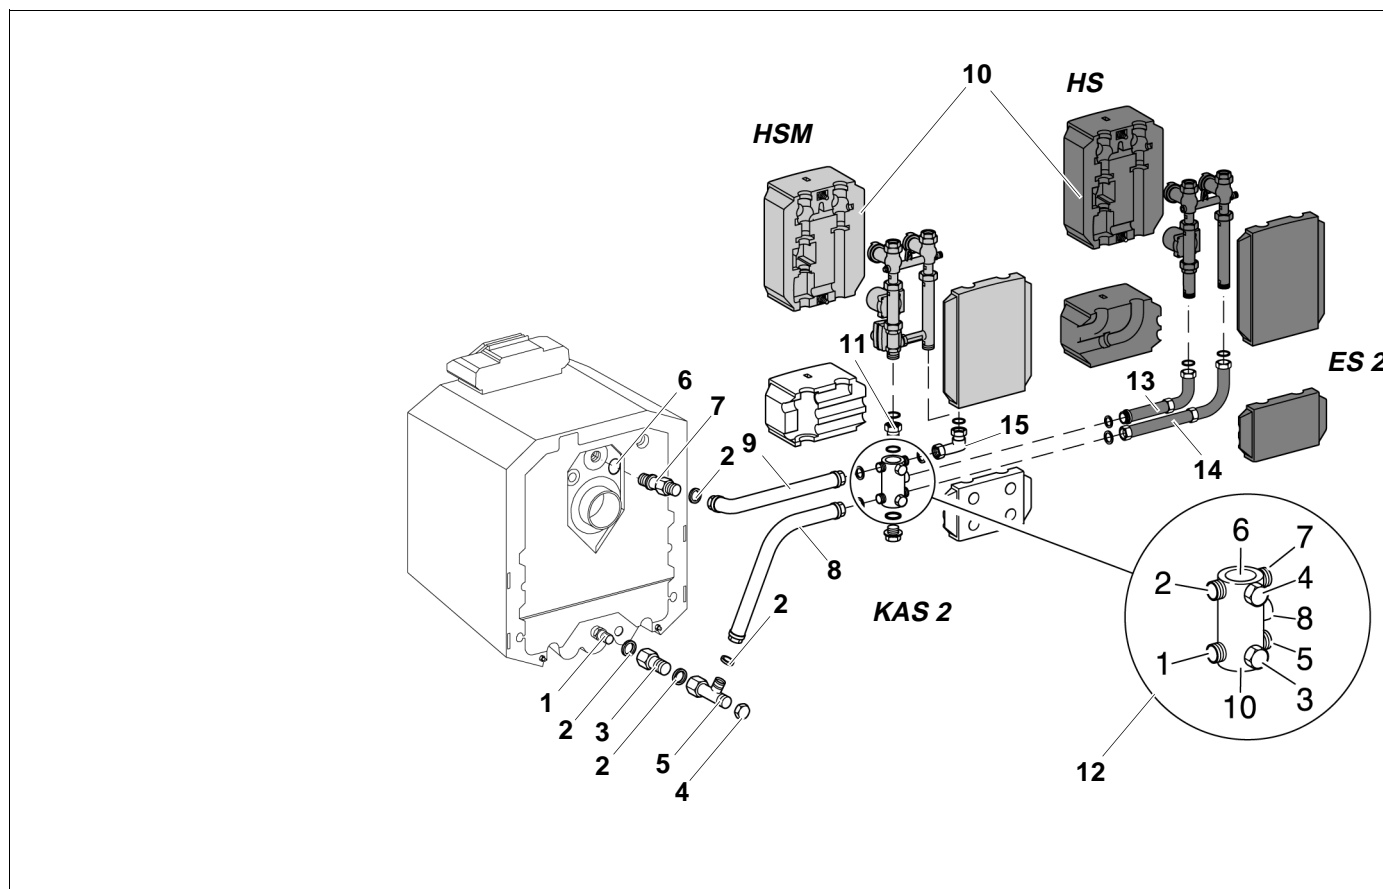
Montaggio perpendicolare laterale a sinistra (rispetto all'asse della caldaia vista dall'alto)
